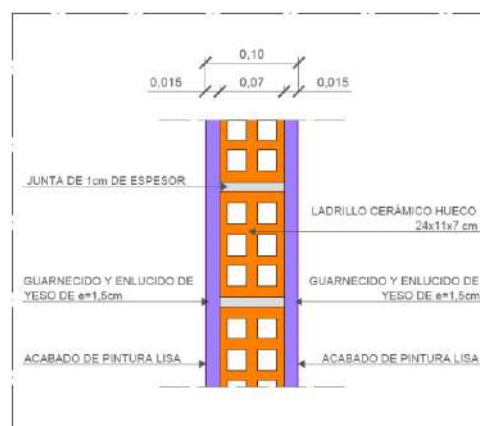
Detalle de tabique divisor zona seca con zona seca. 2016. Fuente Propia
